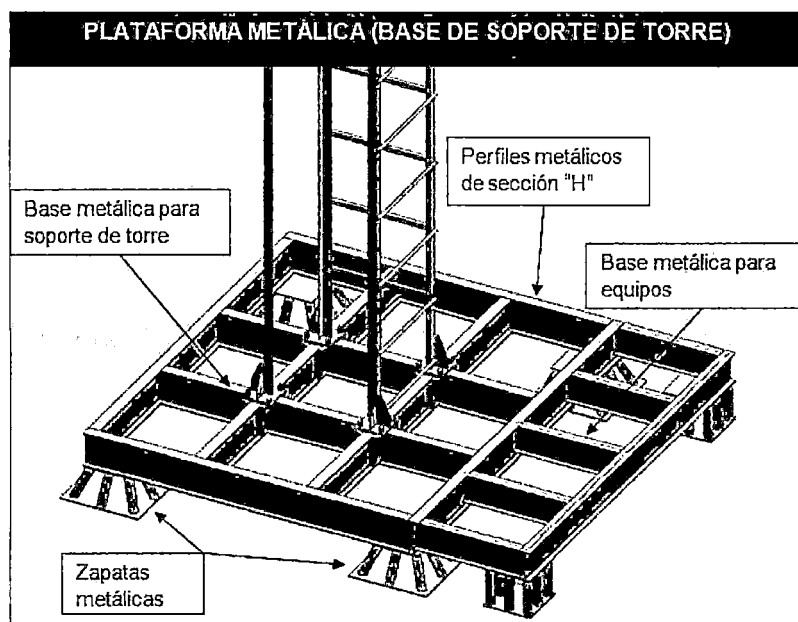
Plataforma metálica armada con perfiles metálicos de sección "H"
